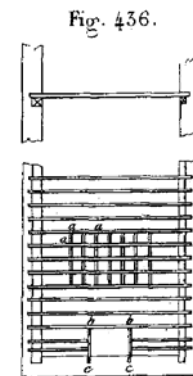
Planta y sección de forjado sobre durmientes en el manual de Valdés. Plan and cross-section of timber floor by Valdés (25).
